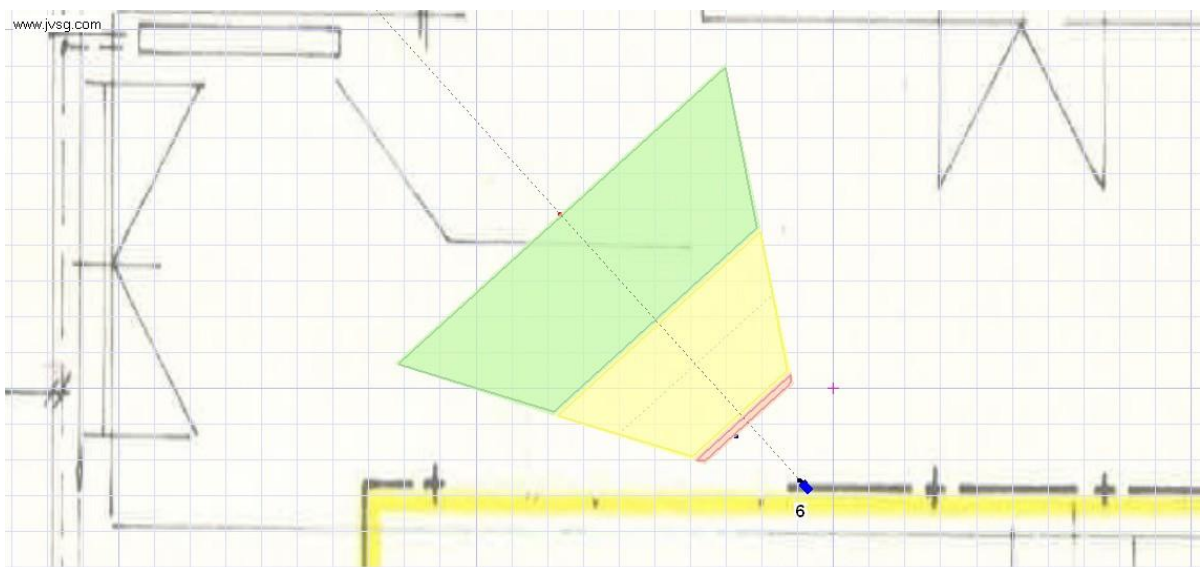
Detail umístění kamery č. 4
